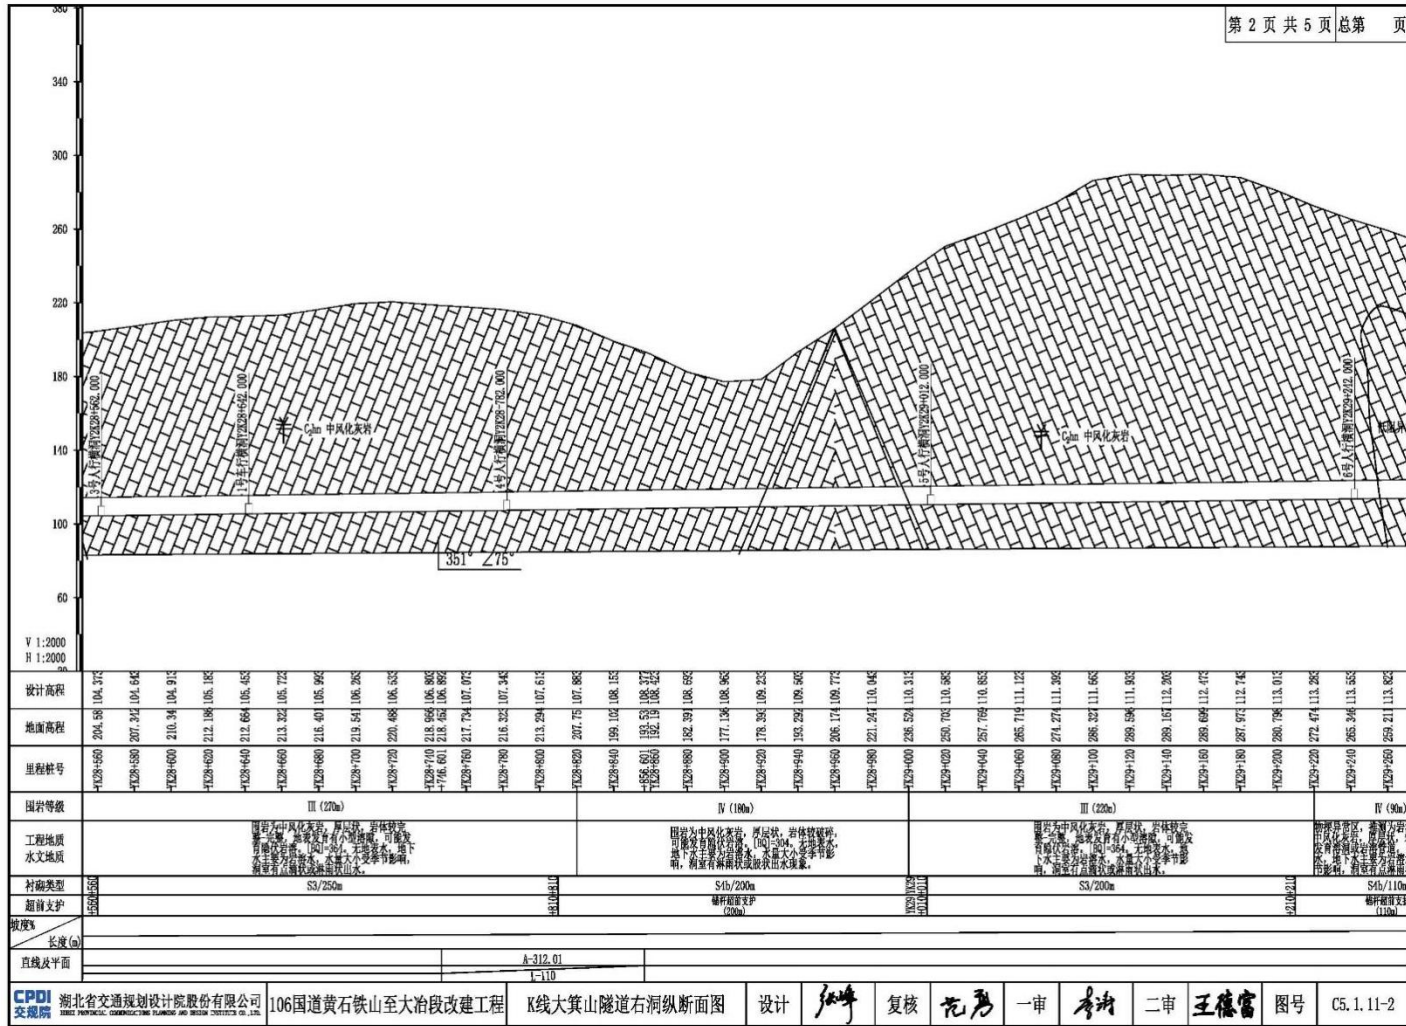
大箕山隧道右洞纵断面图 (二)
